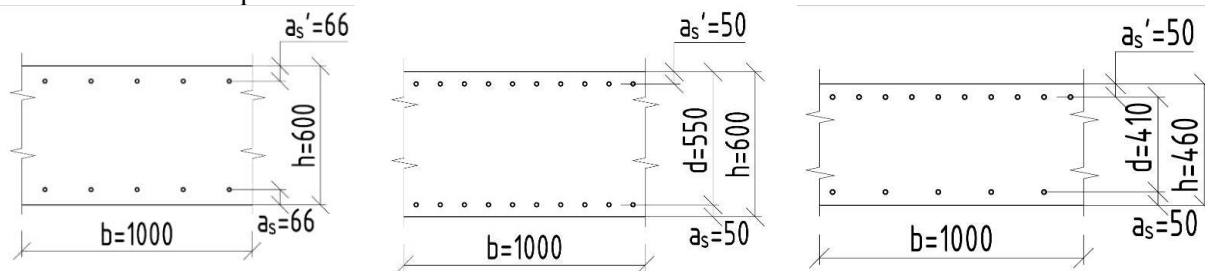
Розрахункові перерізи фундаментної плити для перевірки армування: а – вздовж 0x (вздовж осі тунелю); б – поблизу стінок вздовж 0y, в – в прольоті, вздовж 0y, у місці дренажного лотка
